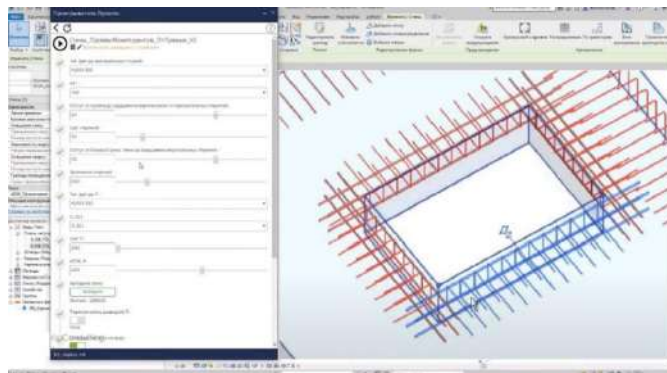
Армирование проема в Revit с использованием Dynamo
